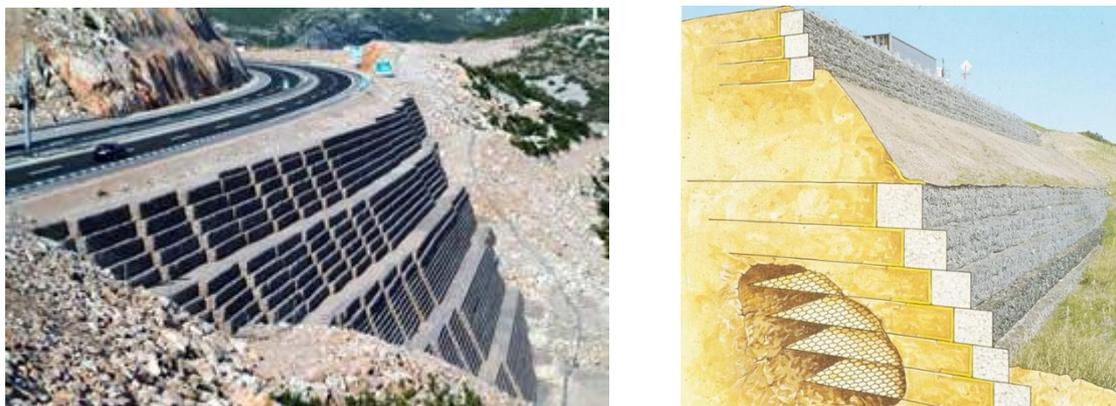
Внешний вид армогрунтовых подпорных стенок
